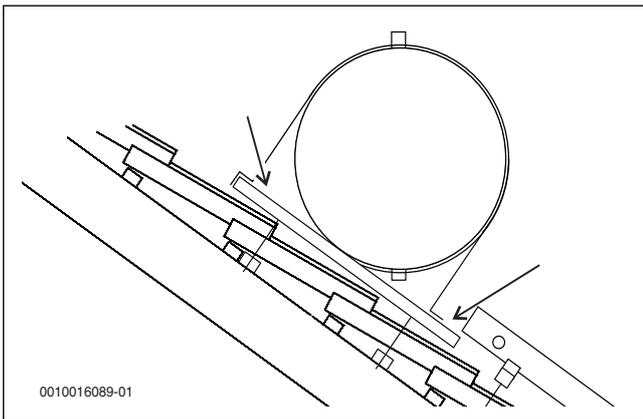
Possibile collegamento del dispositivo di protezione contro i fulmini alle guide profilate dell'accumulatore
